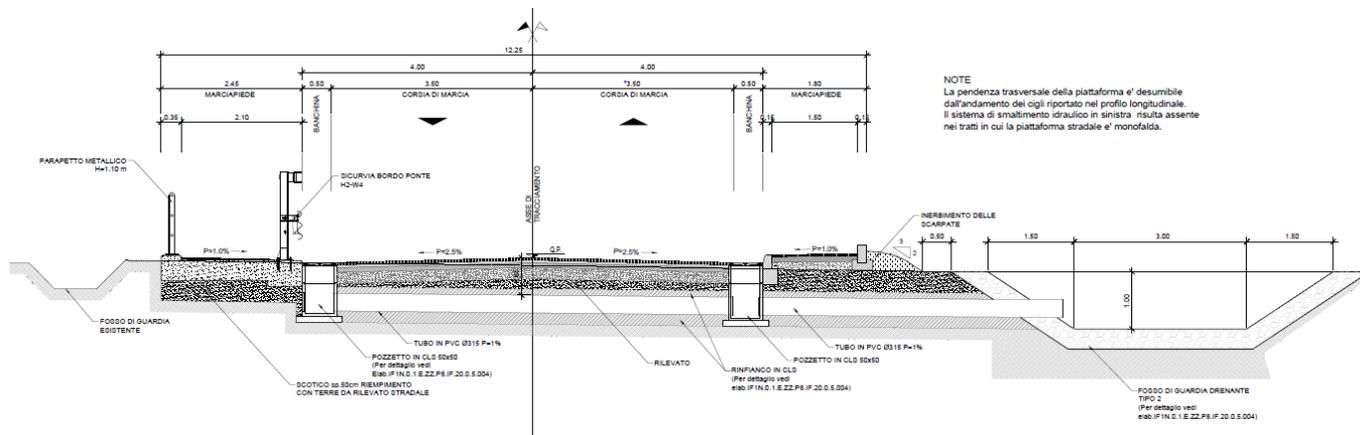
Sezione e pianta tipo tratto da km 0+110 a km 0+365
